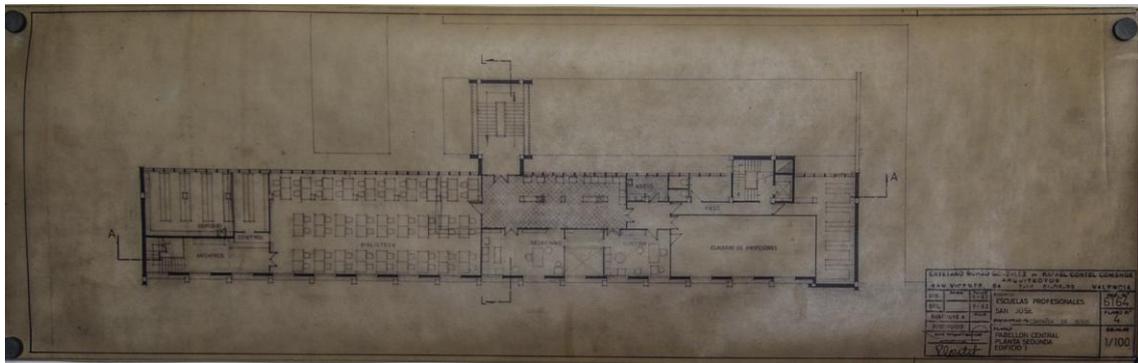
Planta primera. *Archivo Escuelas San José.
